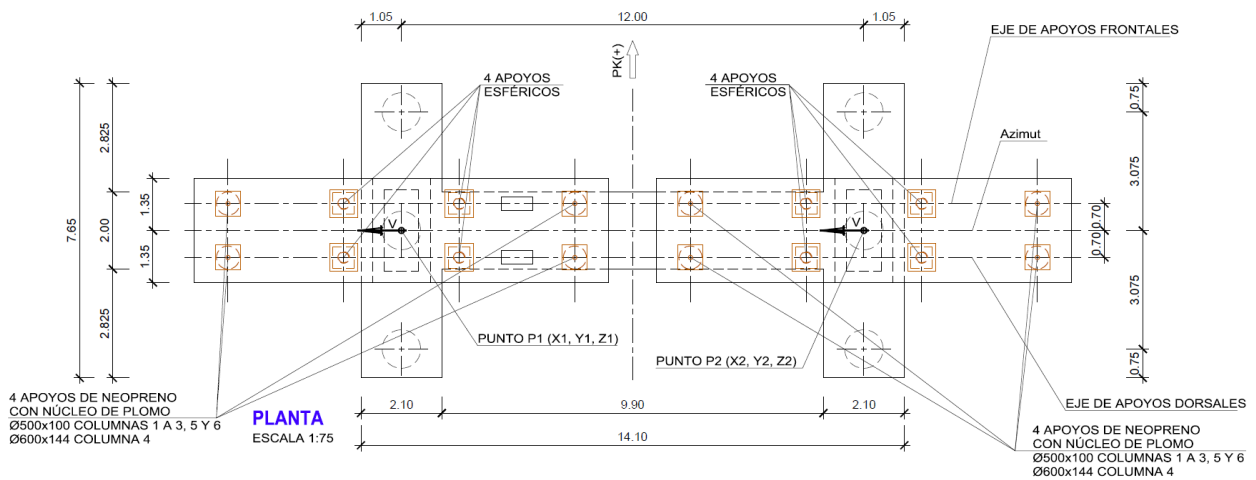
Disposición de los apoyos según se indica en los planos del proyecto.
